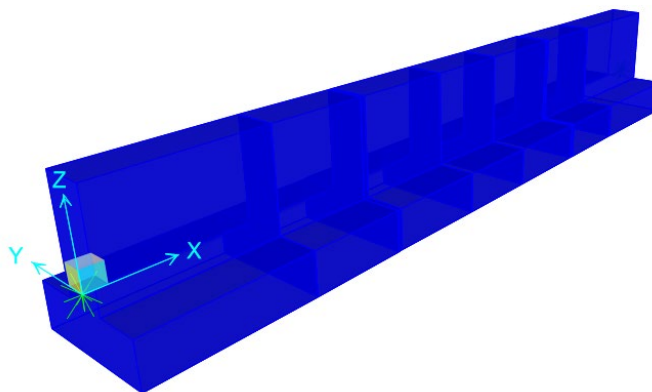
Vista 3D della trave di fondazione in c.c.a.
